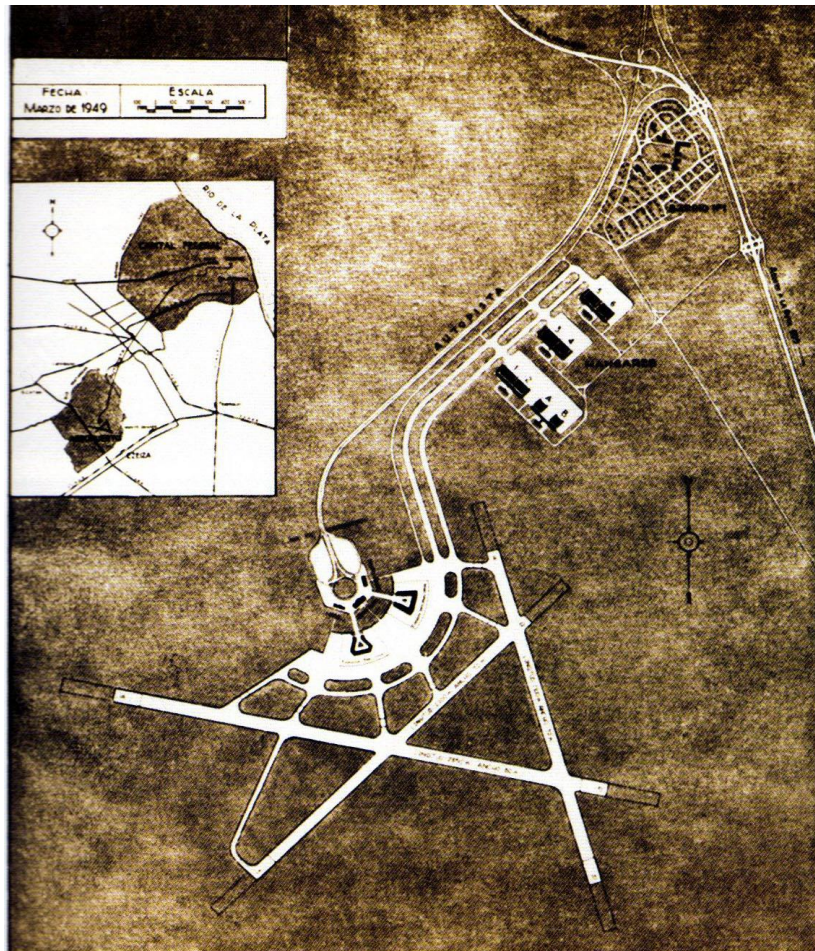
Plano original del proyecto para el Aeropuerto de Ezeiza.
